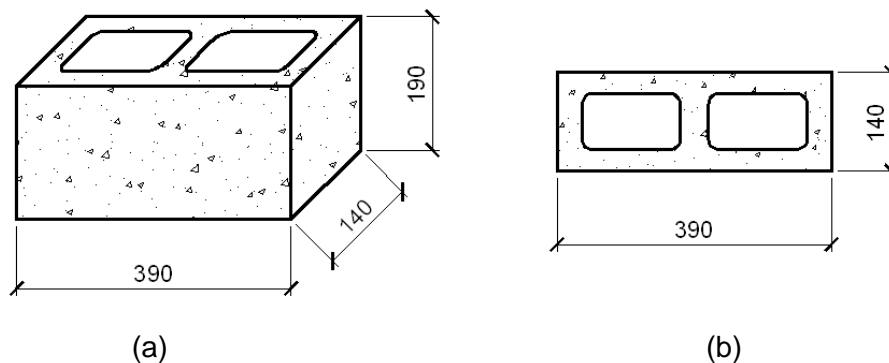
Perspectiva do bloco de concreto (a); face de assentamento (b) (medidas em mm)
